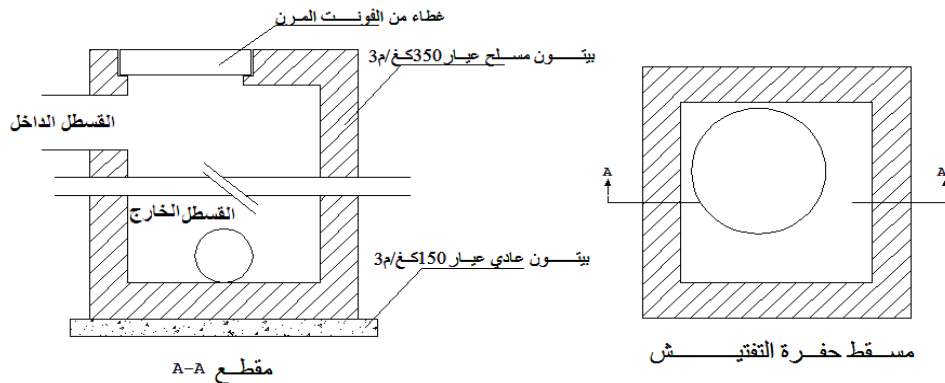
مسقط أفقي ومقطع لحفرة تفتيش دون سقوط
